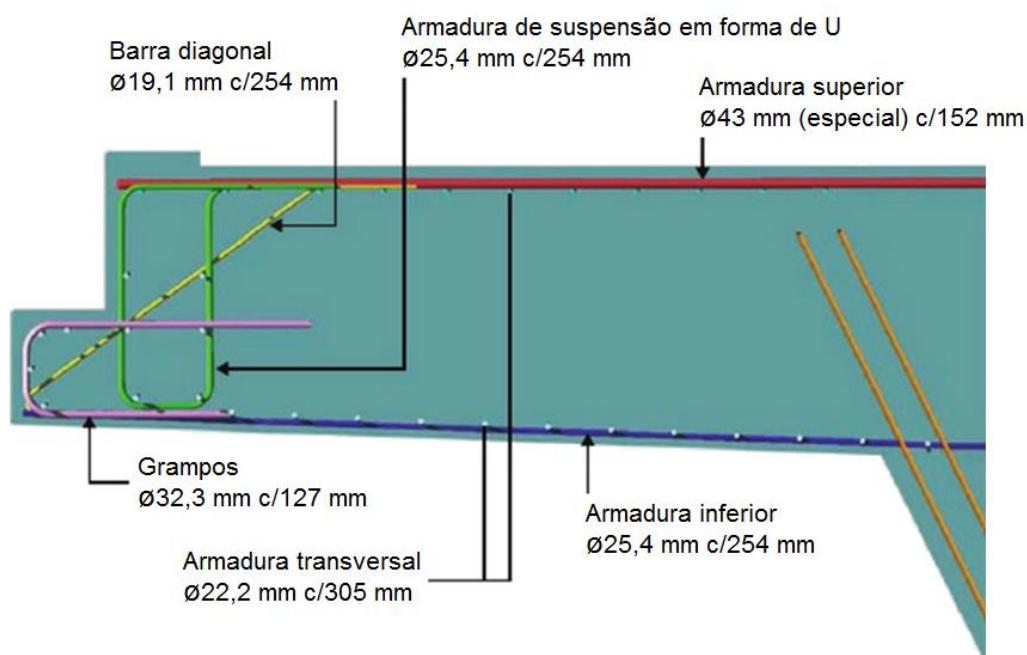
Elevação do viaduto da avenida Concorde.
